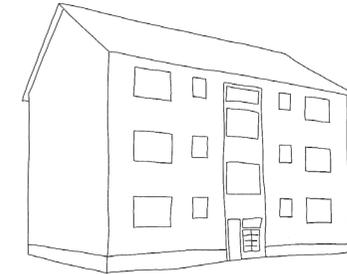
Mehrfamilienhaus mit Schwarzplan
